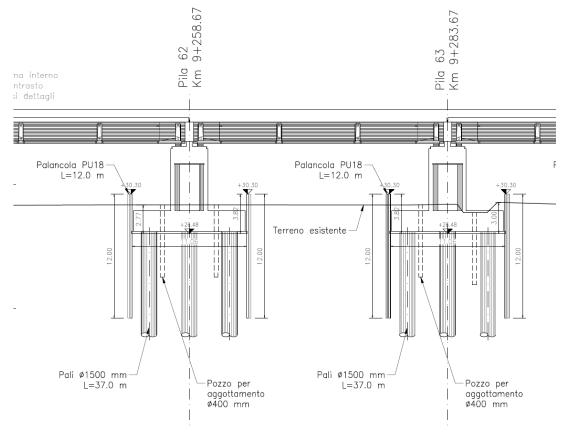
Sezione trasversale tipologica pile con Palancolato a sbalzo
